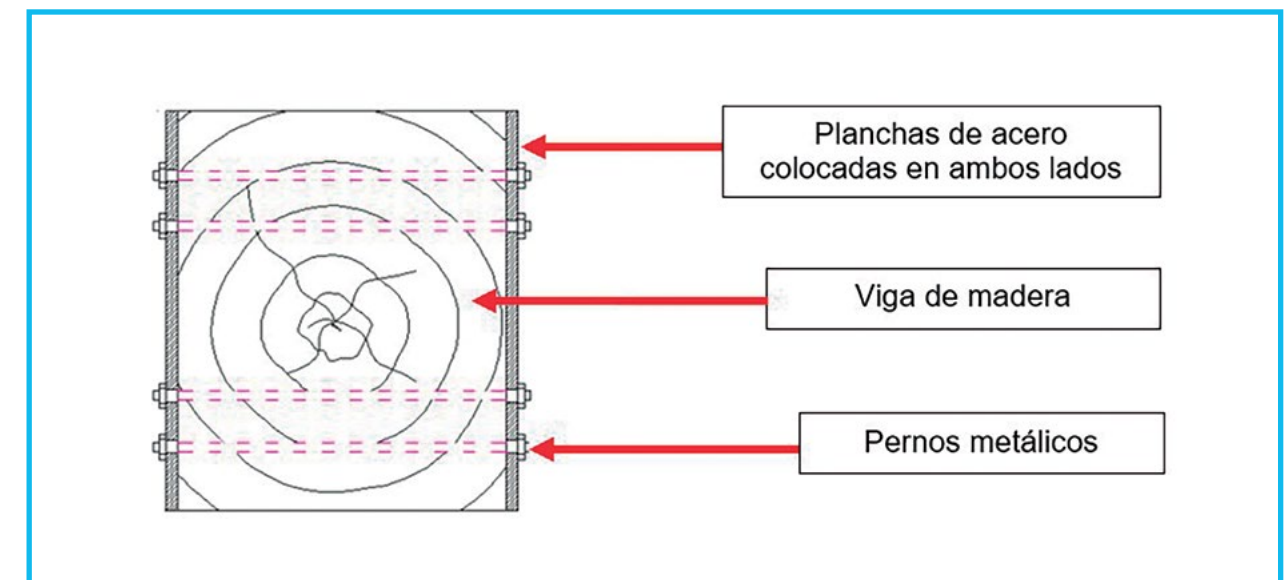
Refuerzo de viga de madera agrietada mediante planchas laterales
